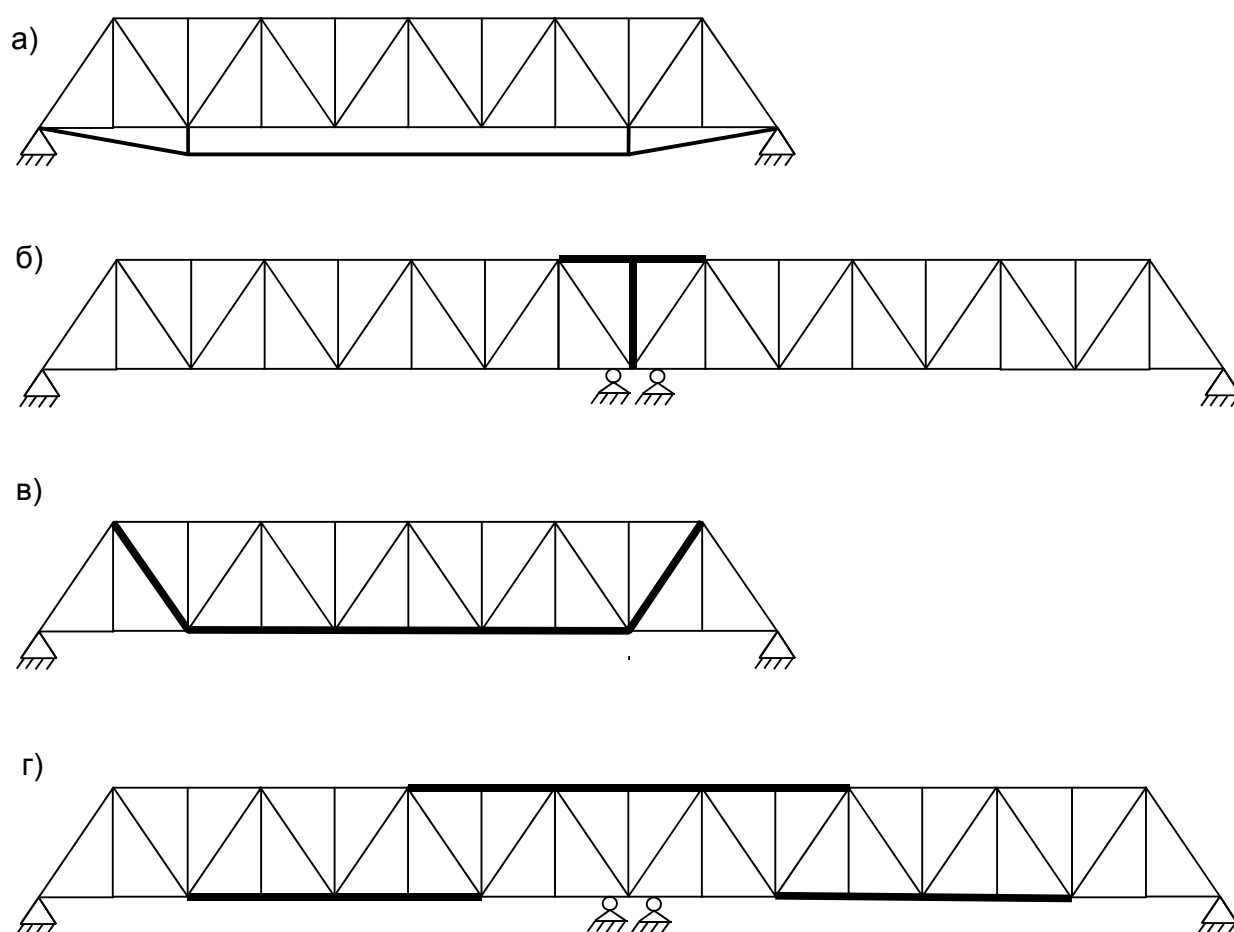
Схема усиления главных ферм: а – подведение шпренгеля; б – объединение разрезных ферм в неразрезные; в – предварительное напряжение, создаваемое затяжками, распределяется на большое число элементов системы; г – вариант усиления неразрезной фермы. Здесь предварительное напряжение затяжек вызывает усилие практически во всех элементах
